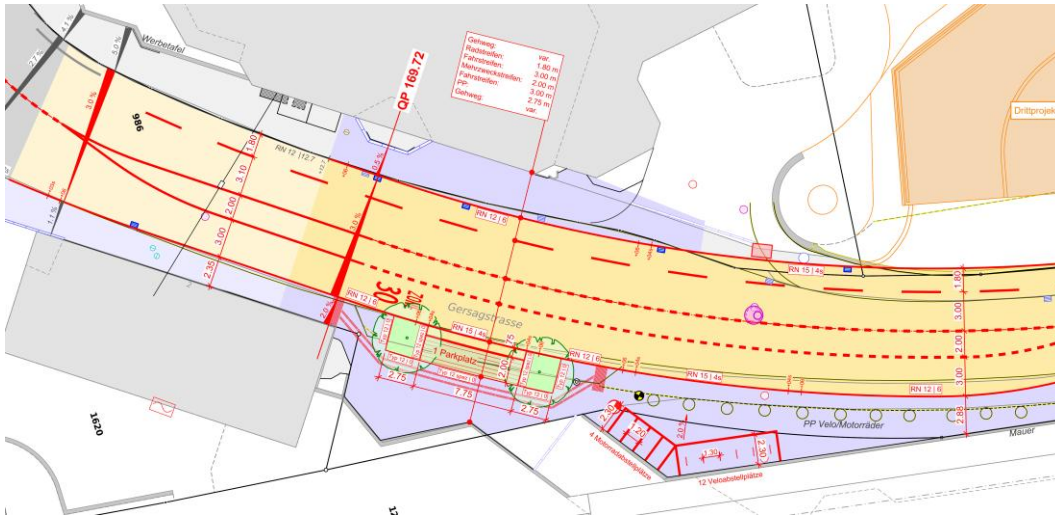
Ausschnitt aus Situationsplan: Parkierung entlang Gersagstrasse
